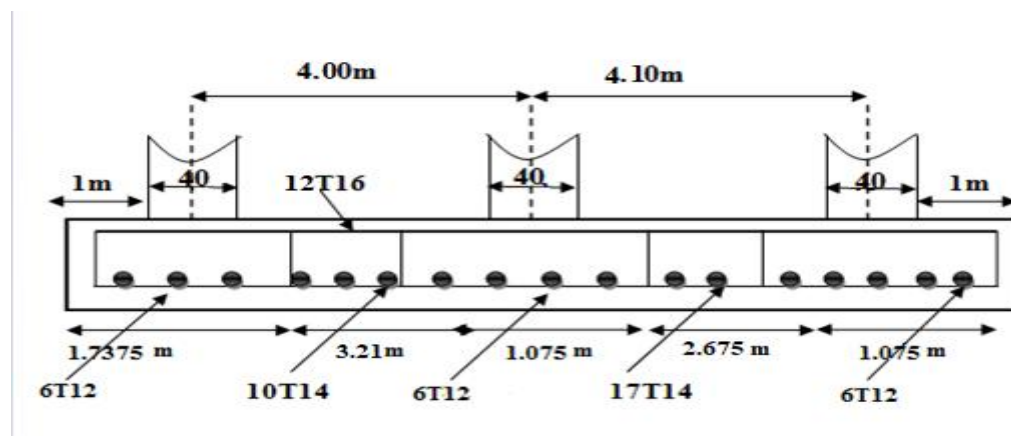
Schéma de ferrailage de la semelle filante.
